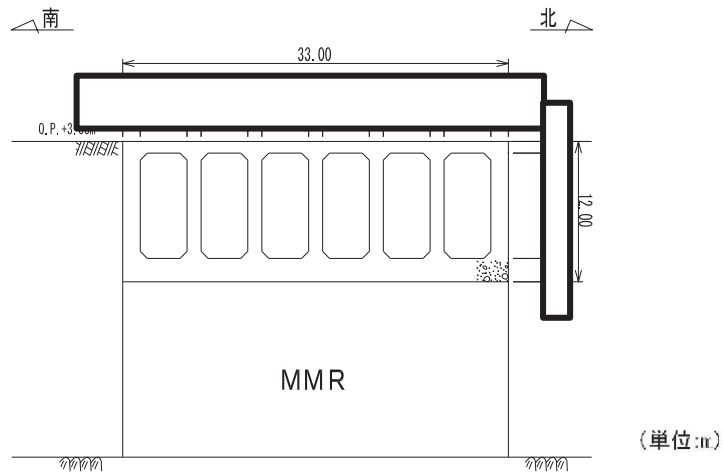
取水口断面図 (A-A 断面，南北 (標準部))
